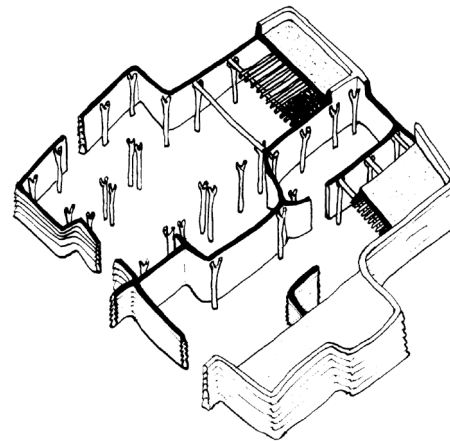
Axonometría seccionada sistema estructural soporte-viga
